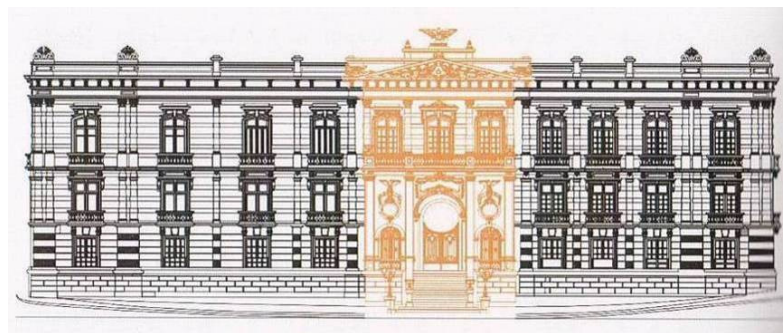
Desenho com o levantamento da fachada Sul/Sudeste do Palácio. E em destaque o pórtico de entrada
